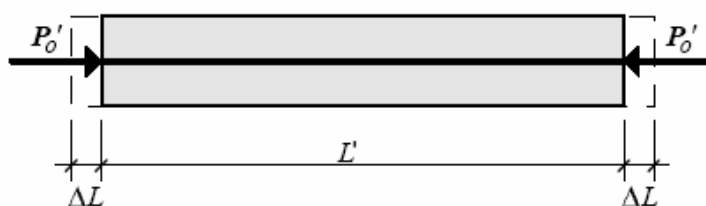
Vigas pré fabricada com armadura pré-tracionada
